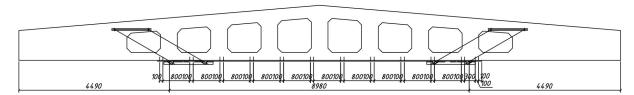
Схема усиленной двускатной решетчатой железобетонной балки.
